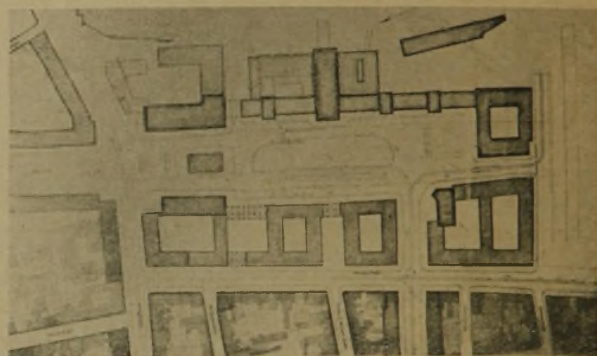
Lageplan zum Entwurf „Gleichgewicht“.
